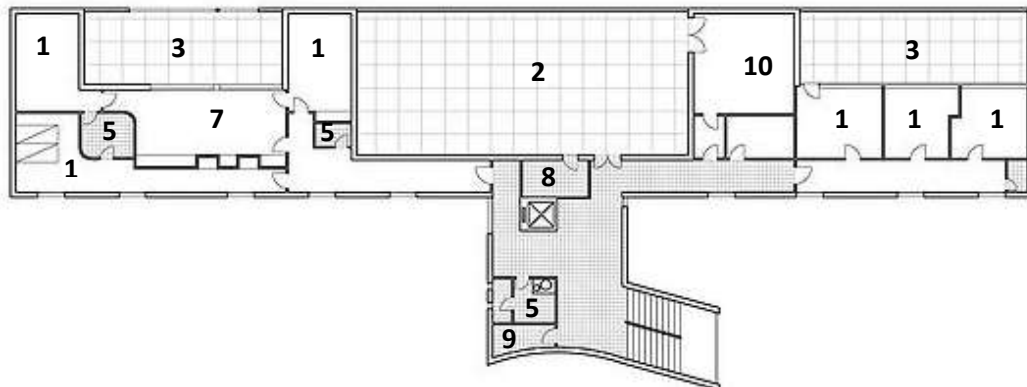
Planta Nível 4. 1: Quarto. 2: Solário. 3: Terraço. 4: Cozinha. 5: Banheiro. 6: Área de serviço. 7: Sala. 8: Depósito. 9: Área de serviço. 10: Sala de música. Pavilhão Suíço, em Paris, França. Fonte: Archdaily.
